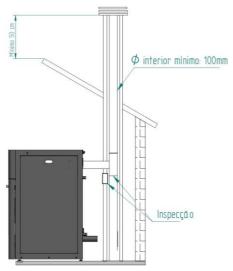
Vista lateral da instalação com chaminé, com exemplo do ponto de inspecção.
